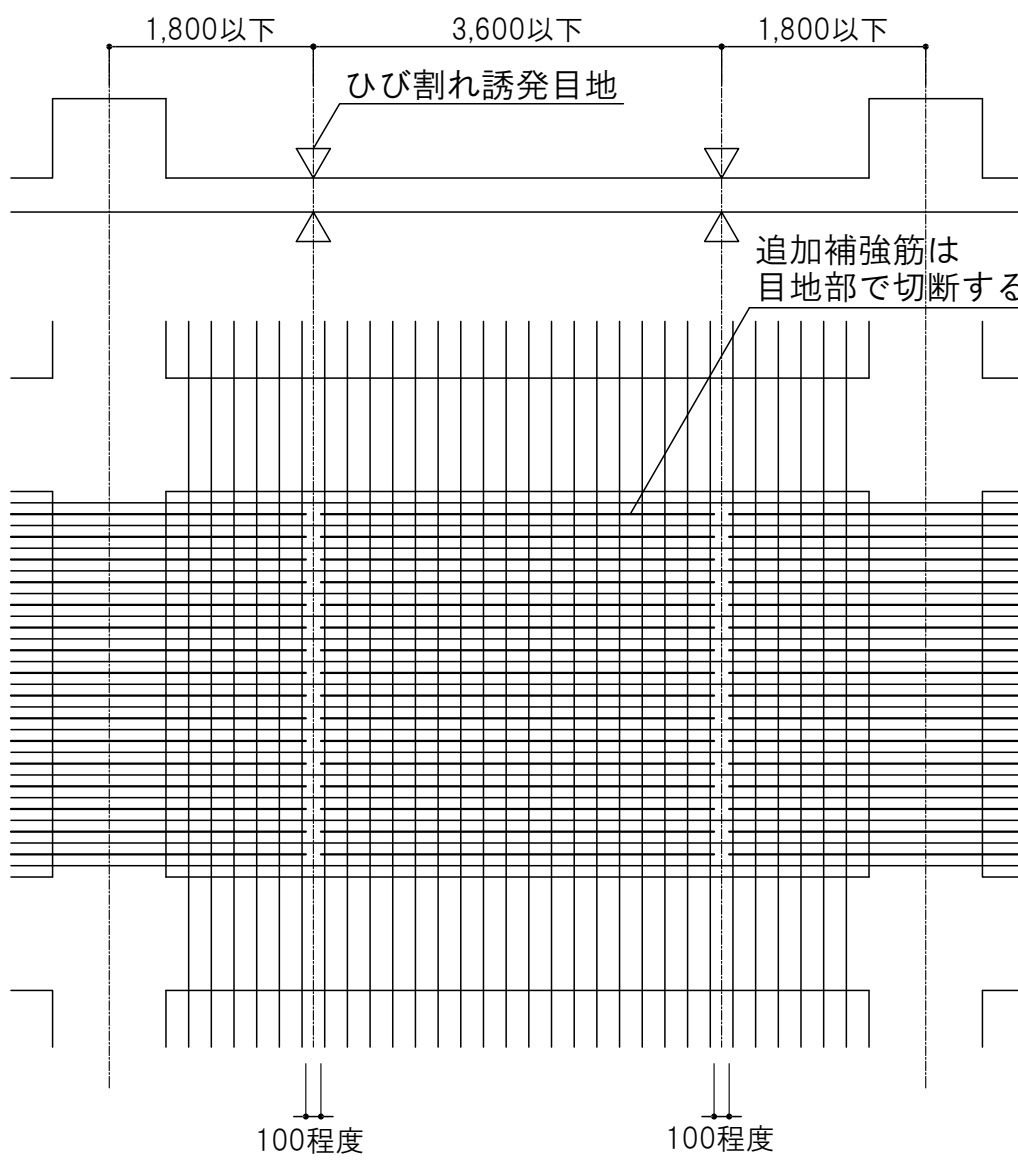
1－4－1 外壁のひび割れ誘発目地位置および追加補強筋
